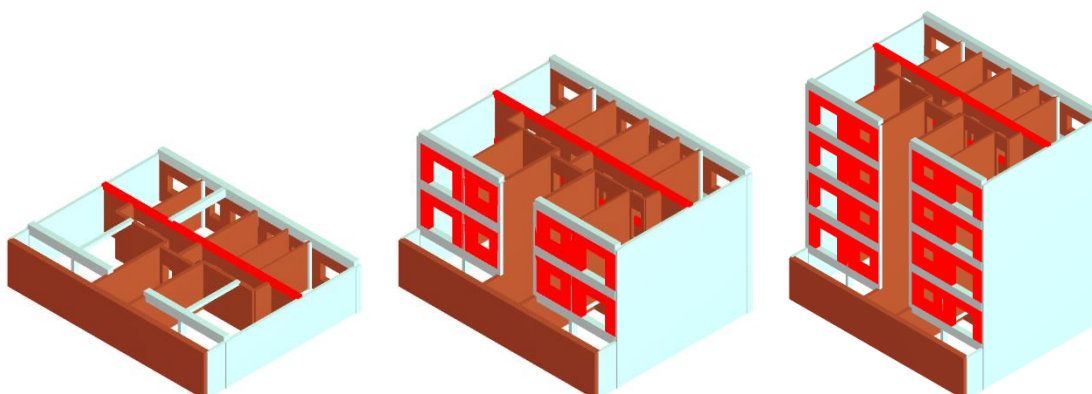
Esquema de introdução da viga de contraventamento ao nível do pavimento em cada piso em uma parede interior segundo a direção X, e do reboco armado na fachada principal, rés-do-chão (esq.), 2º piso (meio) e cobertura (dirt.).
